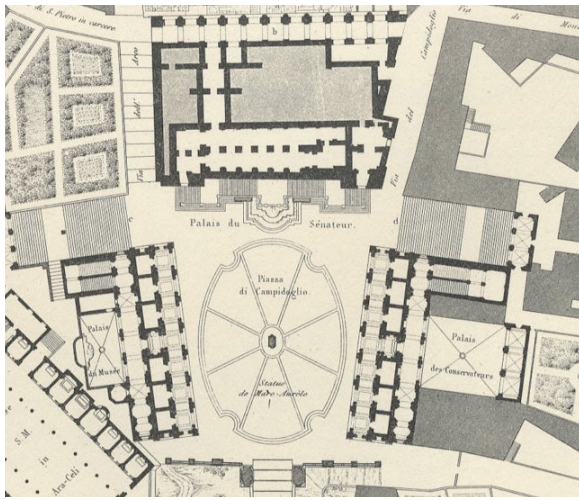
Planta da Praça do Capitólio, em Roma, de Michelangelo.
